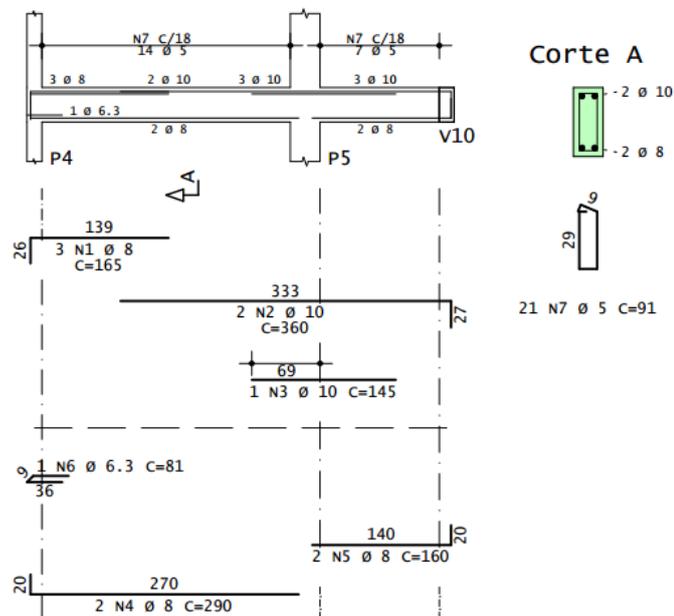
Armadura da viga baldrame V4 – pavimento térreo (nível 0,00)
